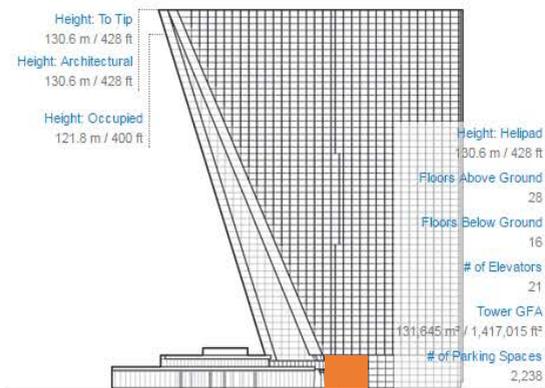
Fachada Poniente. Imagen: Archivo TGL
